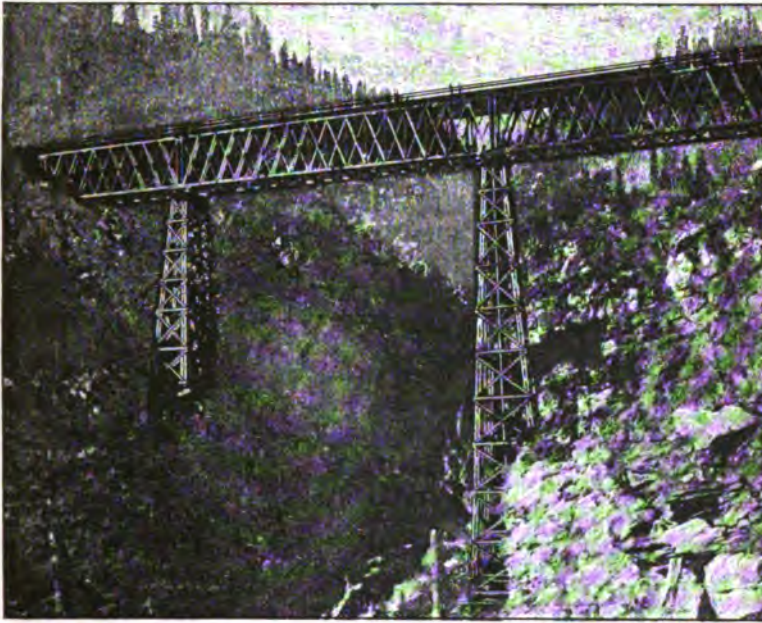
Viaduc sur le Stony Creek (Canadian Pacific-Railway).
